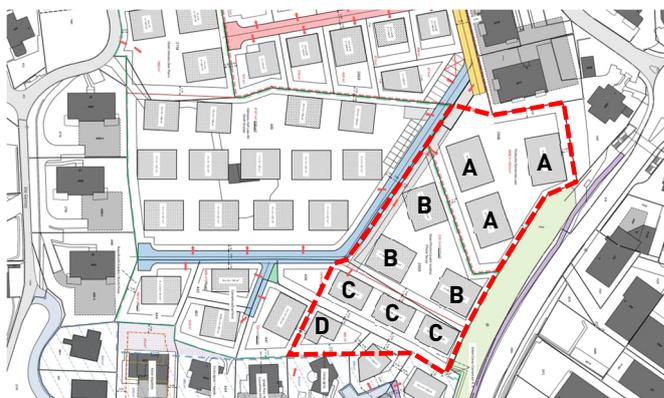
Plan «Groberschliessung zukünftige Einzoning» mit möglicher Bebauung in der WMZ 3
